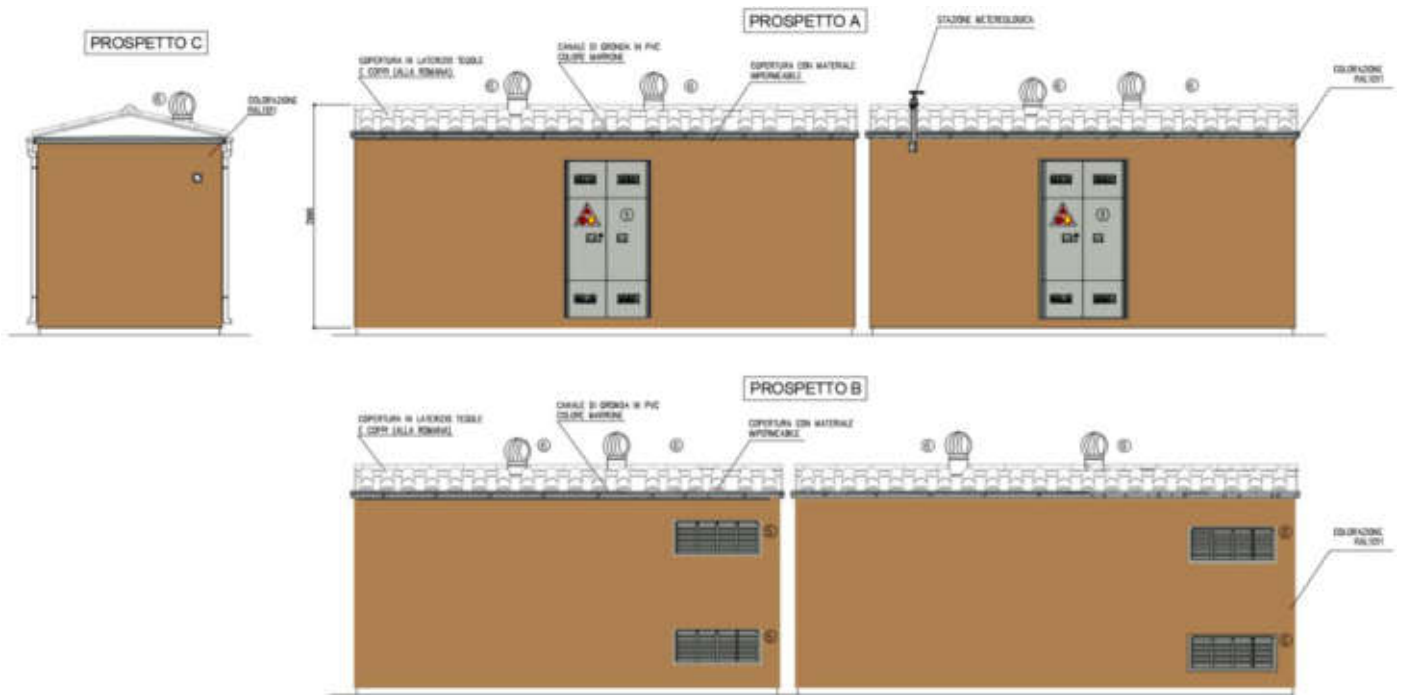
Prospetto della cabina di ricezione (Lotto 2)
